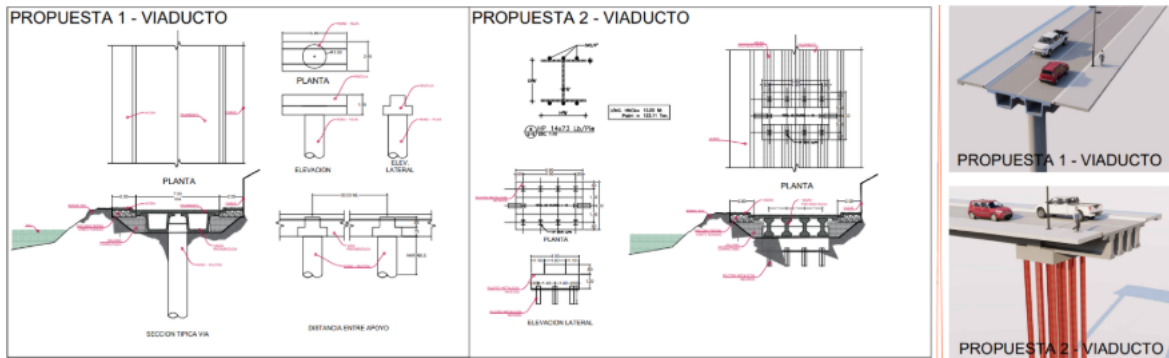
Propuesta de viaductos para la construcción de vía. Fuente: URBE, octubre 2025
